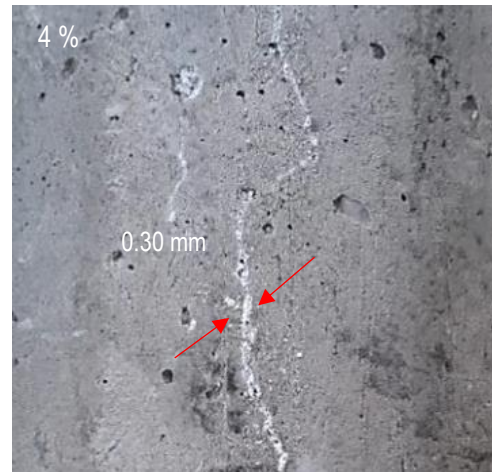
Anchos de fisuras por contracción plástica.
